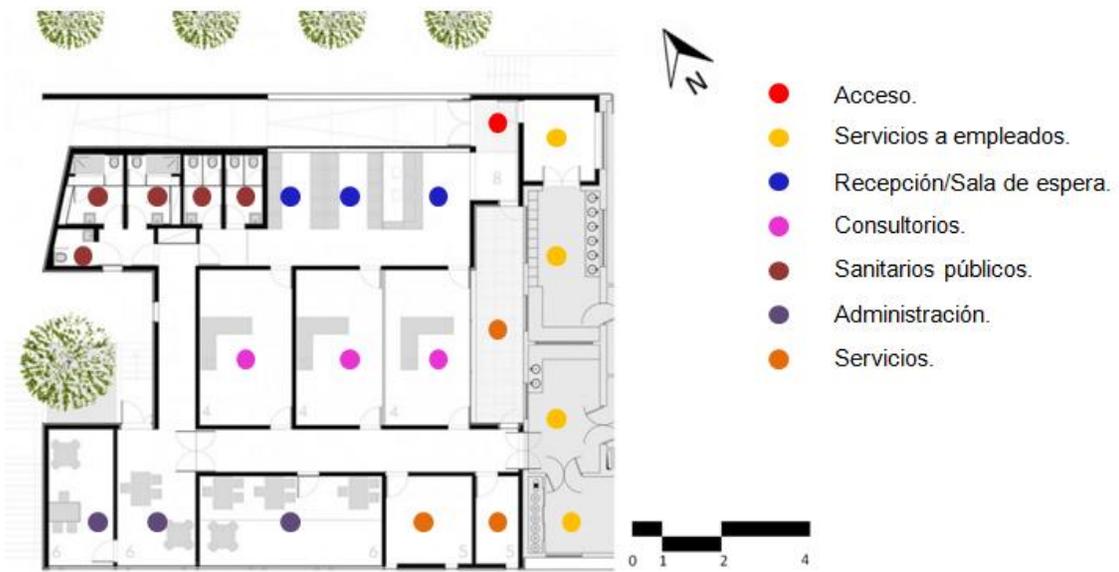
Sección de planta arquitectónica de consultorios. Fuente [www.arhdaily.com.mx](http://www.arhdaily.com.mx).
